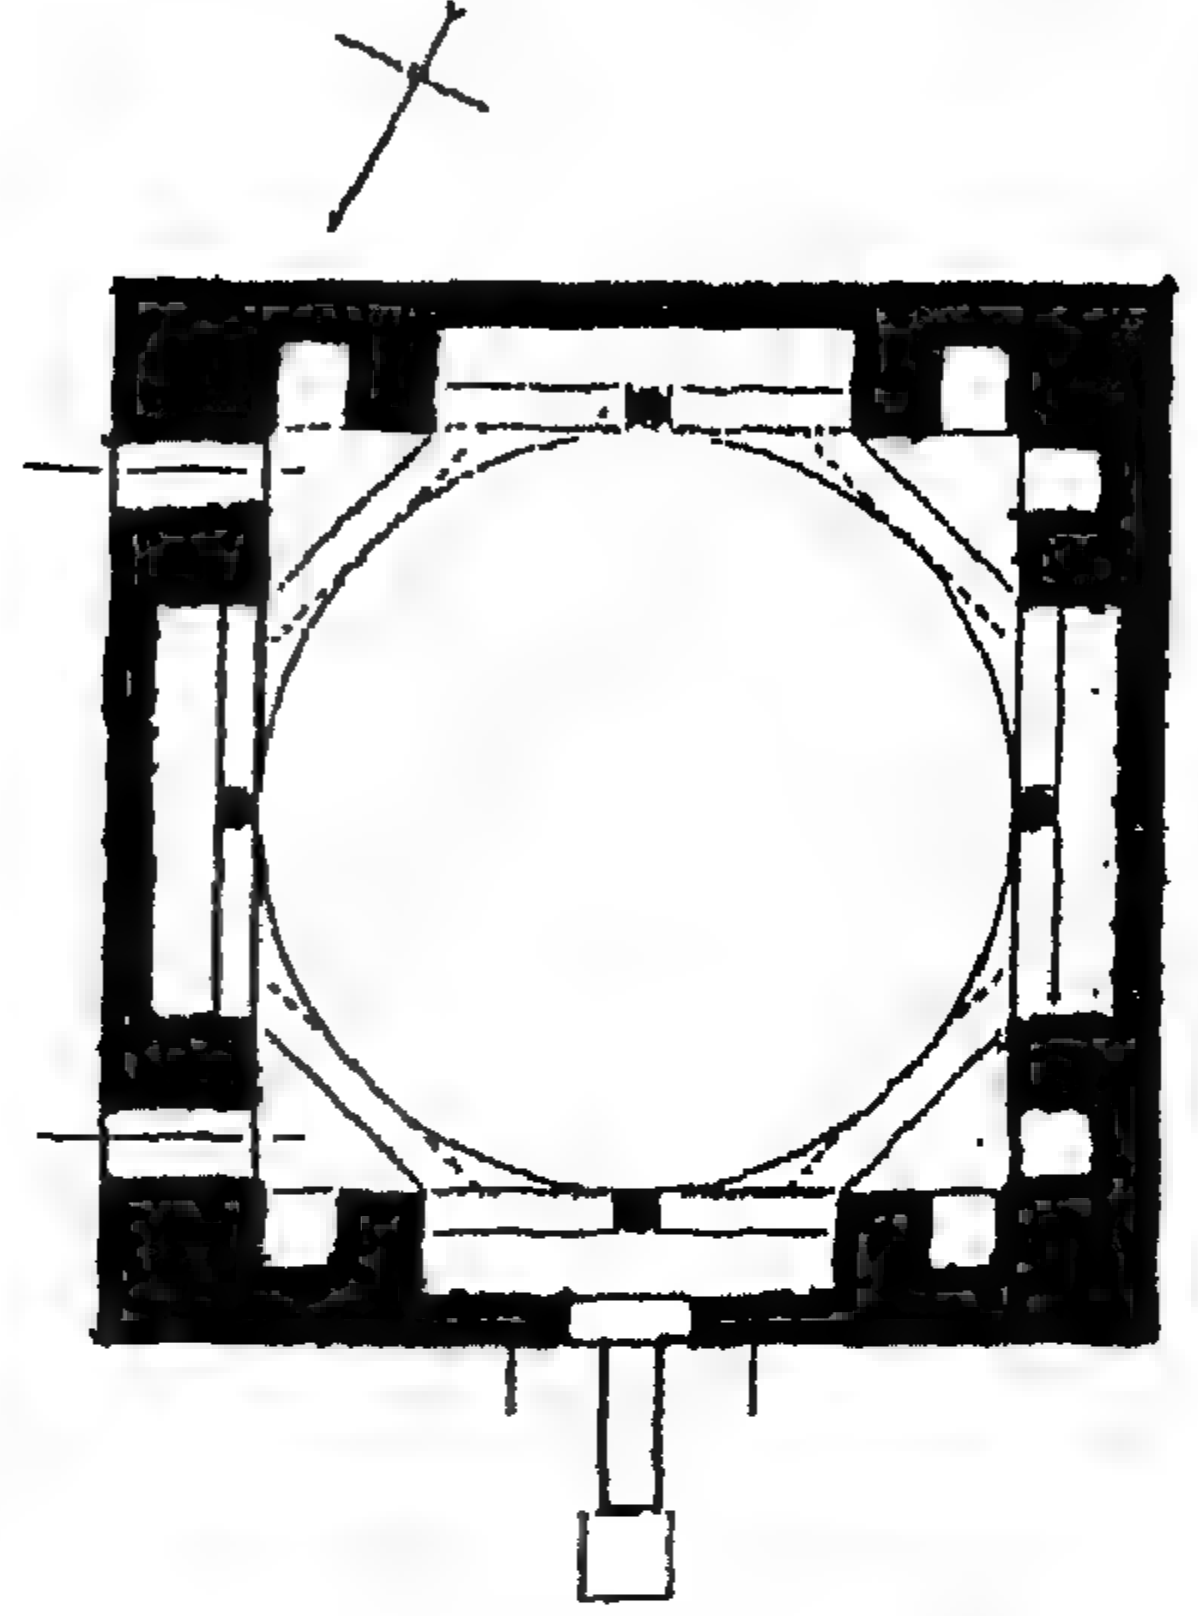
مسقط أفقي لمقصورة الأمير نوروز المعروفة بإيوان ريحان
